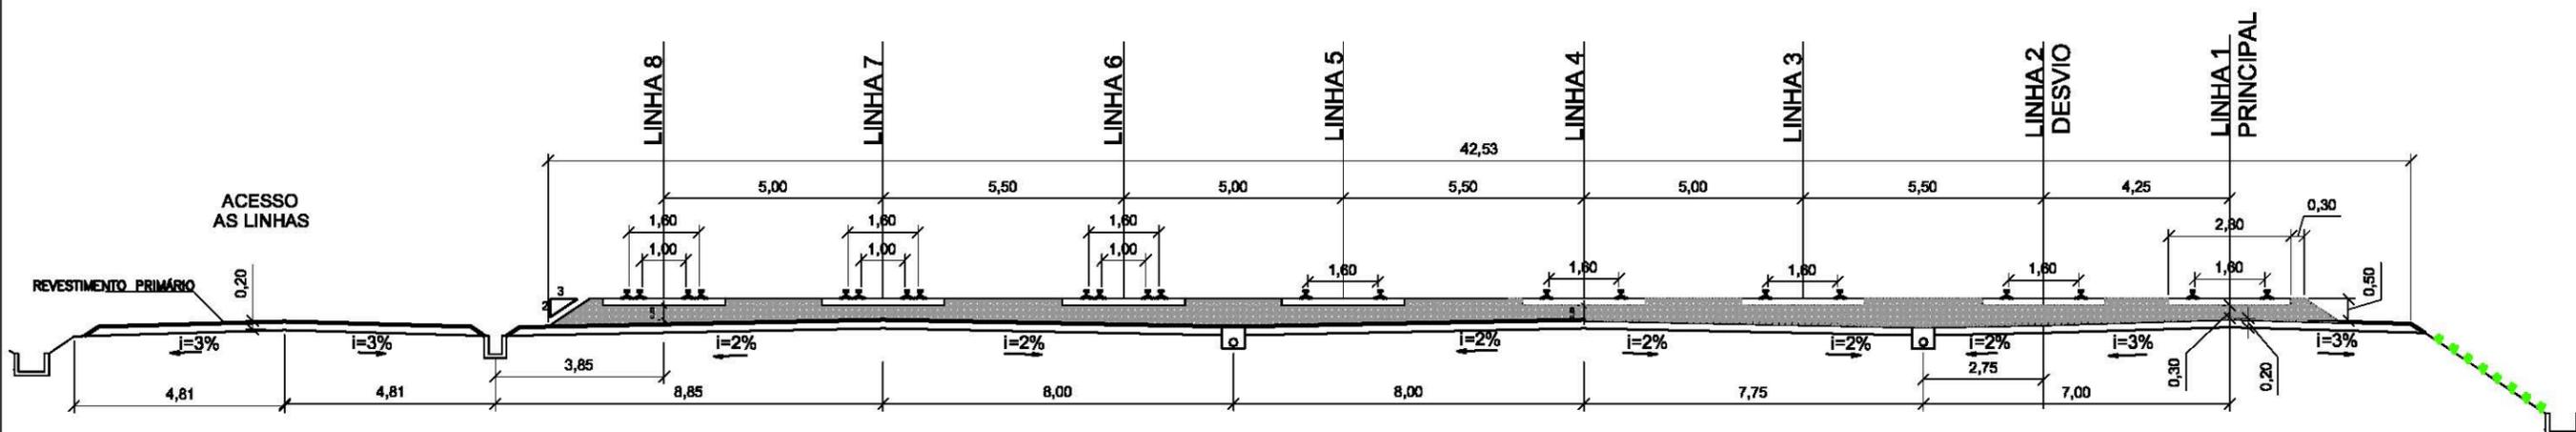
Layout Final do Pátio (Implantação 2ª Etapa)
